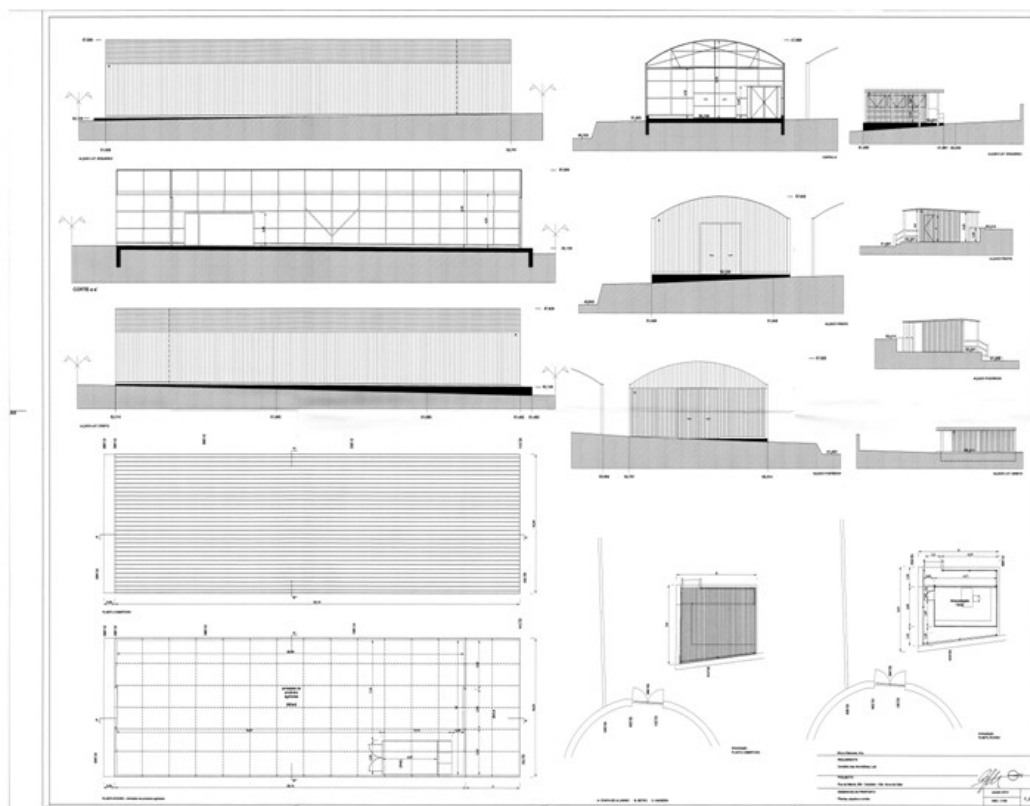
Desenhos de proposta do pavilhão de secagem e armazenamento da empresa Cantinho das Aromáticas, Janeiro de 2010, escala 1:100.
